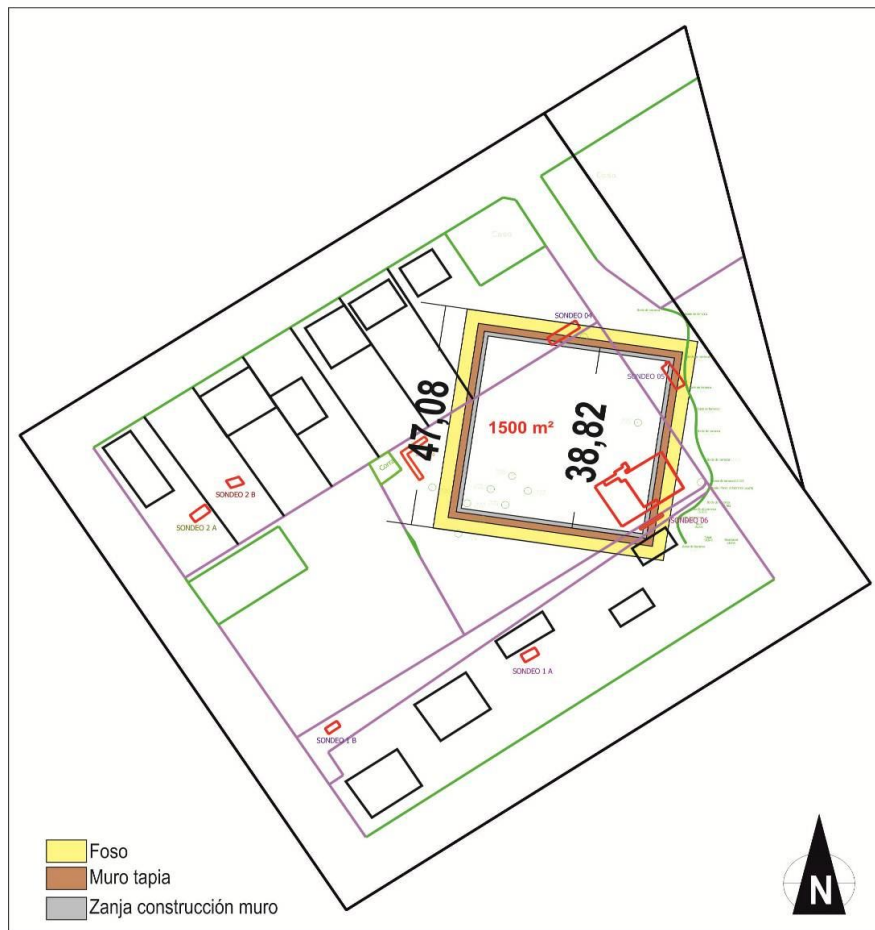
Planimetría del sitio donde se observa la extensión del muro y el foso del fuerte
